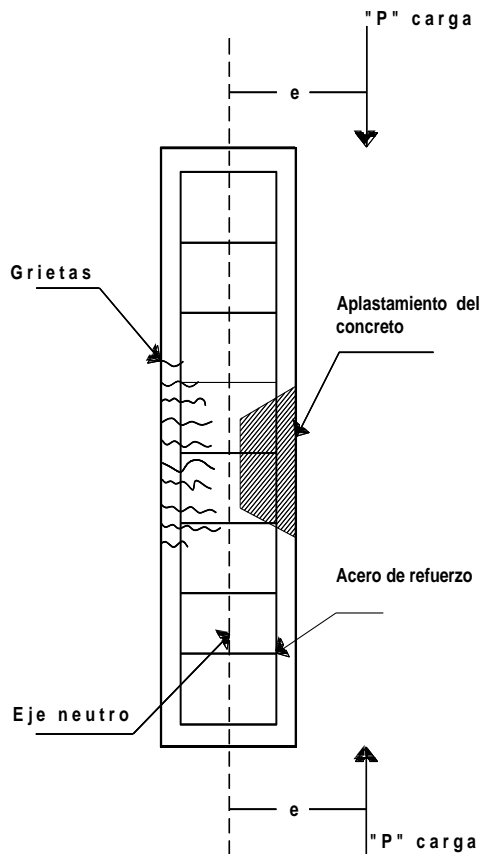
Modos de falla de una columna de concreto presforzado bajo la aplicación de carga excéntrica
